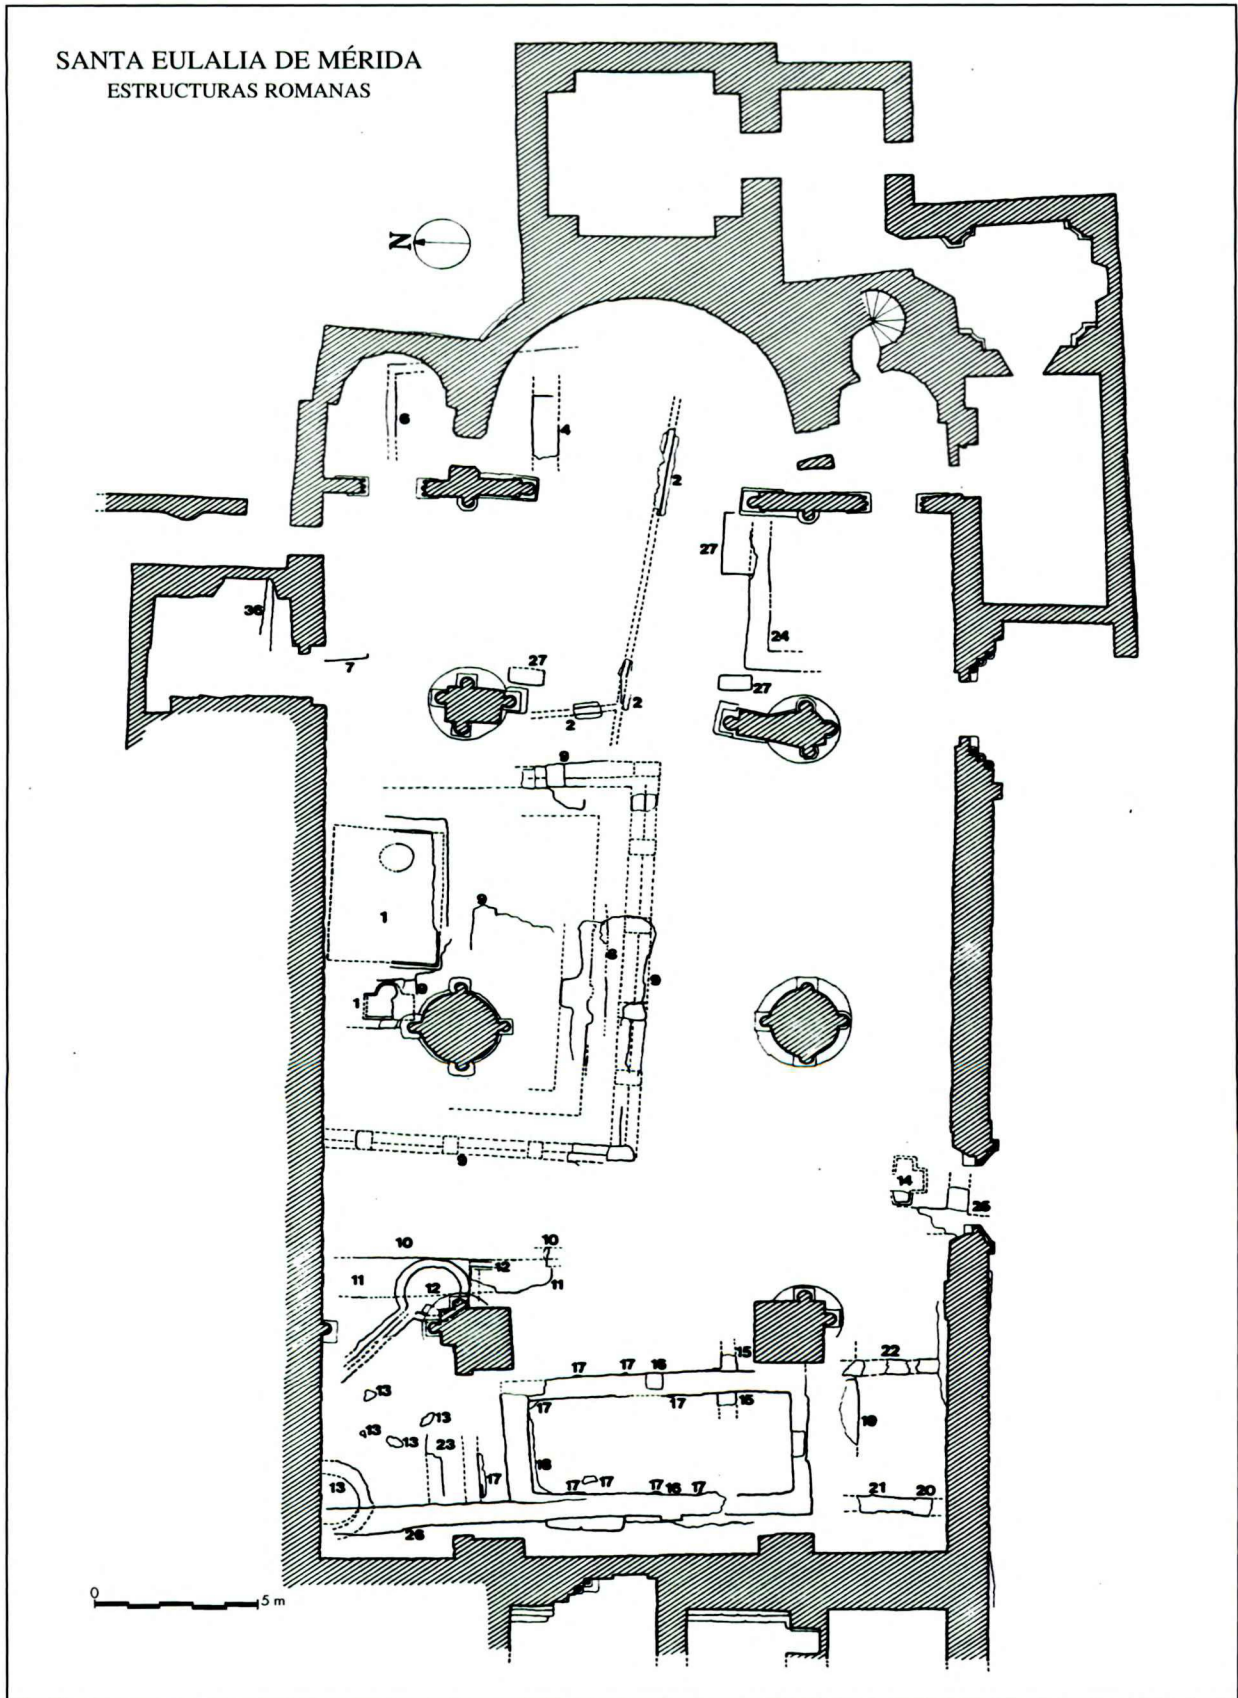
Planta con las estructuras de época romana identificadas en la excavación.
